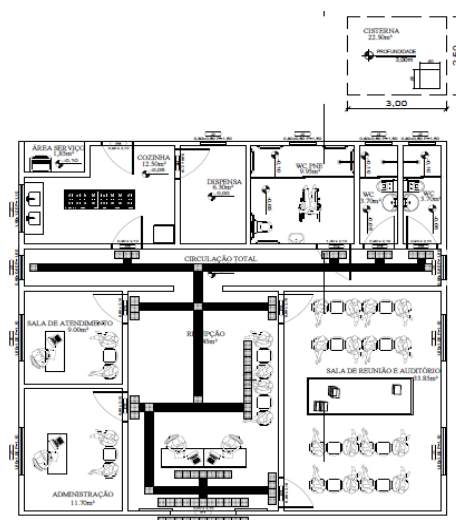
Planta da edificação tradicional Fonte: Autoria Própria (2018)
